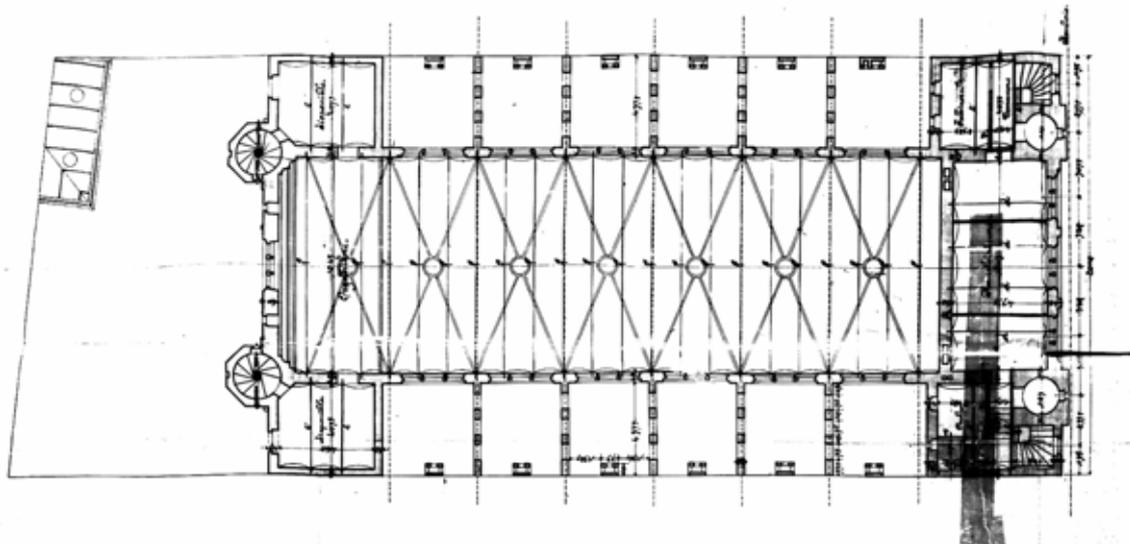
Grundriss in Orgelbühnenhöhe
